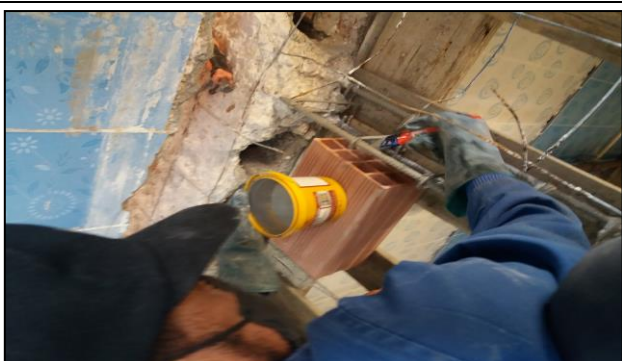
Protection la armature de nervure et poutrelle, poutre et en utilisant (Sika monotop1010)(Anti-corrosion). [8]
